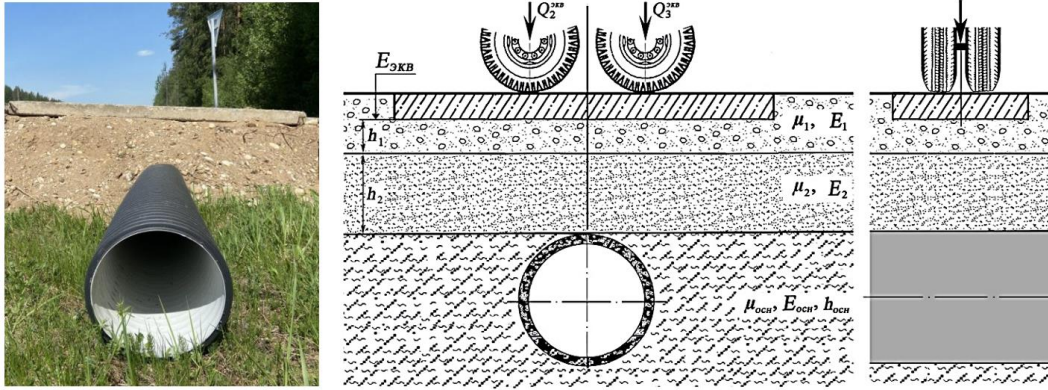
Общий вид и схема передачи транспортной нагрузки на гибкую трубу через дорожные железобетонные плиты
